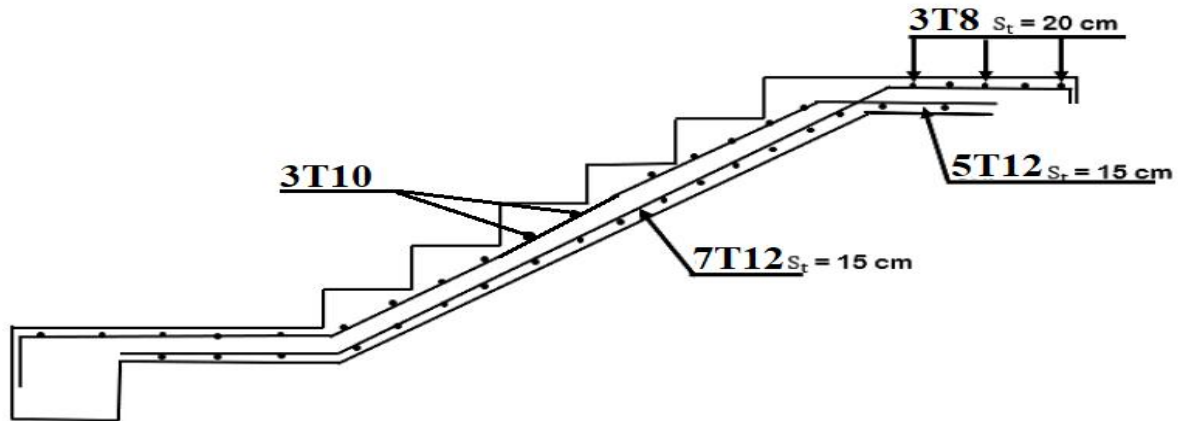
Schéma de ferrailage d'escalier type 1.
